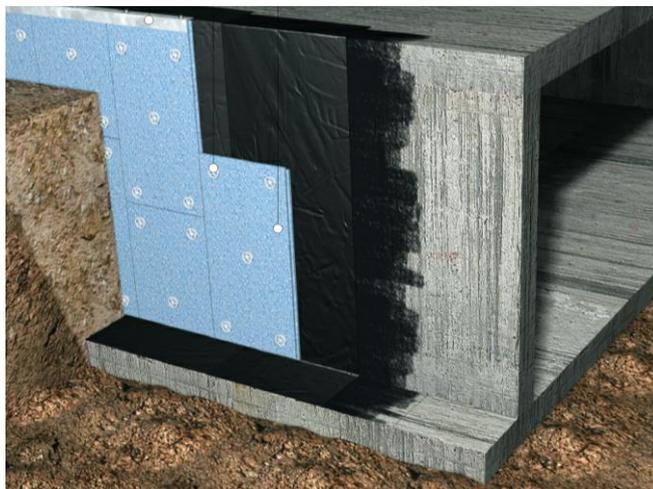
Impermeabilización con lámina asfáltica y aislamiento con placas de poliestireno extruido
